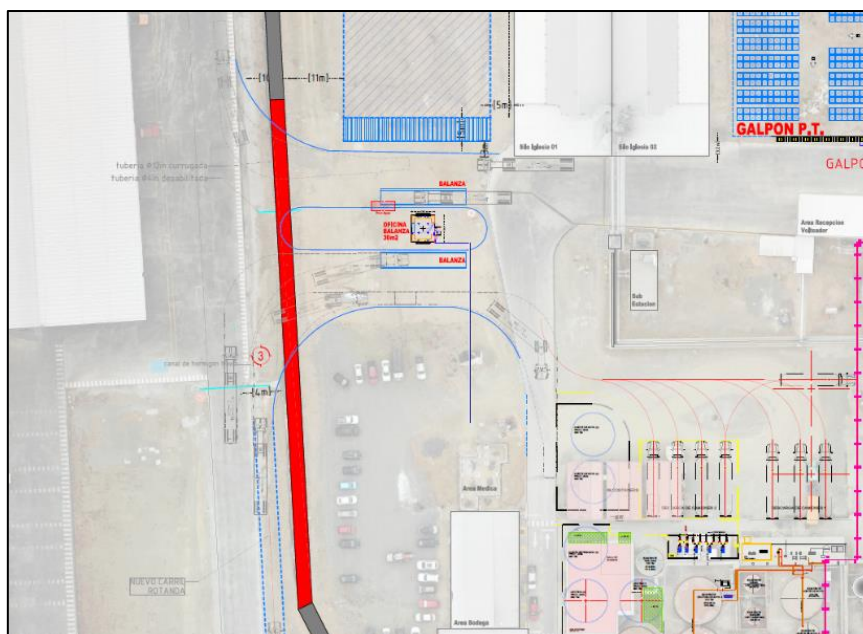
Vista de Planta – Nuevas estructuras viales.
